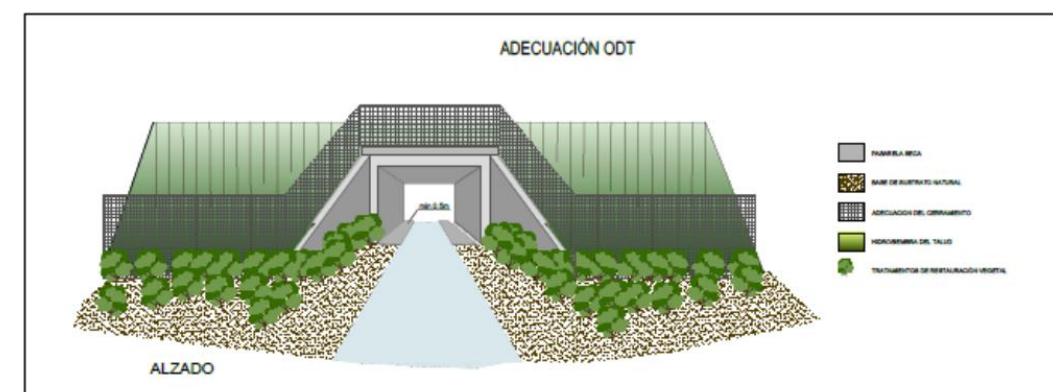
Detalle tipo de las adaptaciones en las Obras de Drenaje Transversal.
